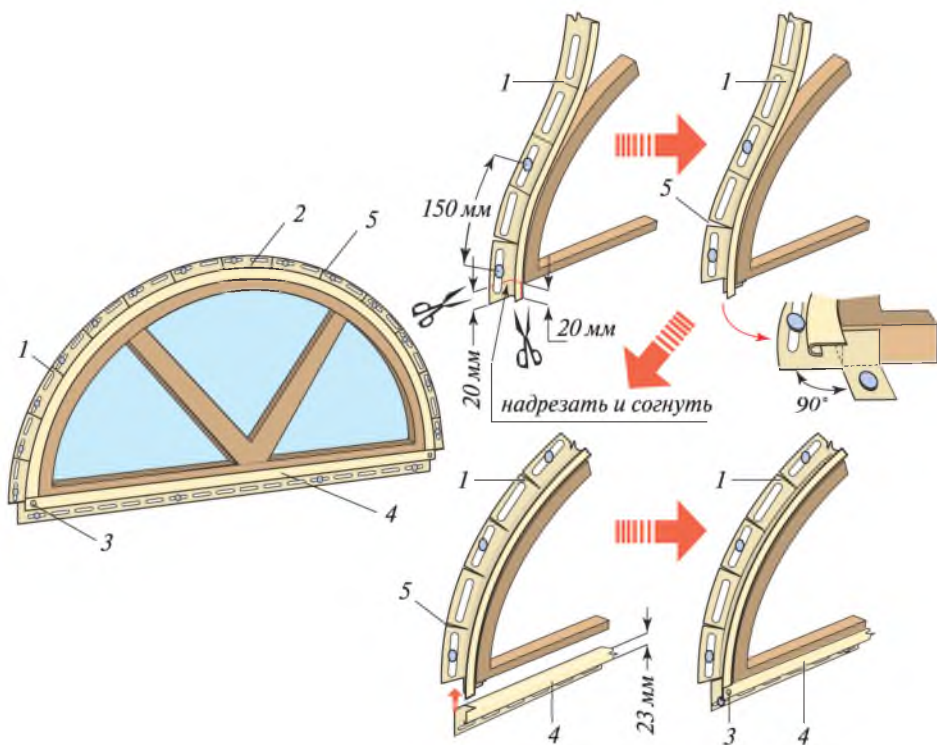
Установка обрамлений вокруг арочных и круглых окон: 1 — гибкий J-профиль; 2 — крепеж; 3 — заклепки; 4 — нижняя обвязка, обычный J-профиль
